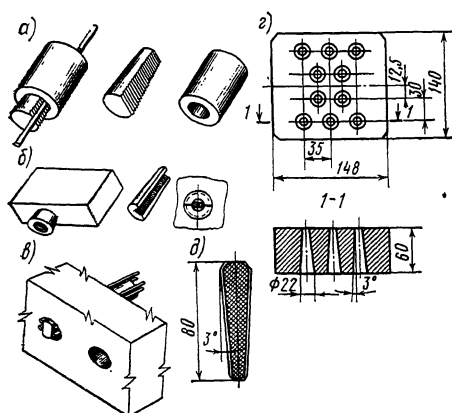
Приспособления для закрепления проволоочной арматуры в напряженно-армированных конструкциях
